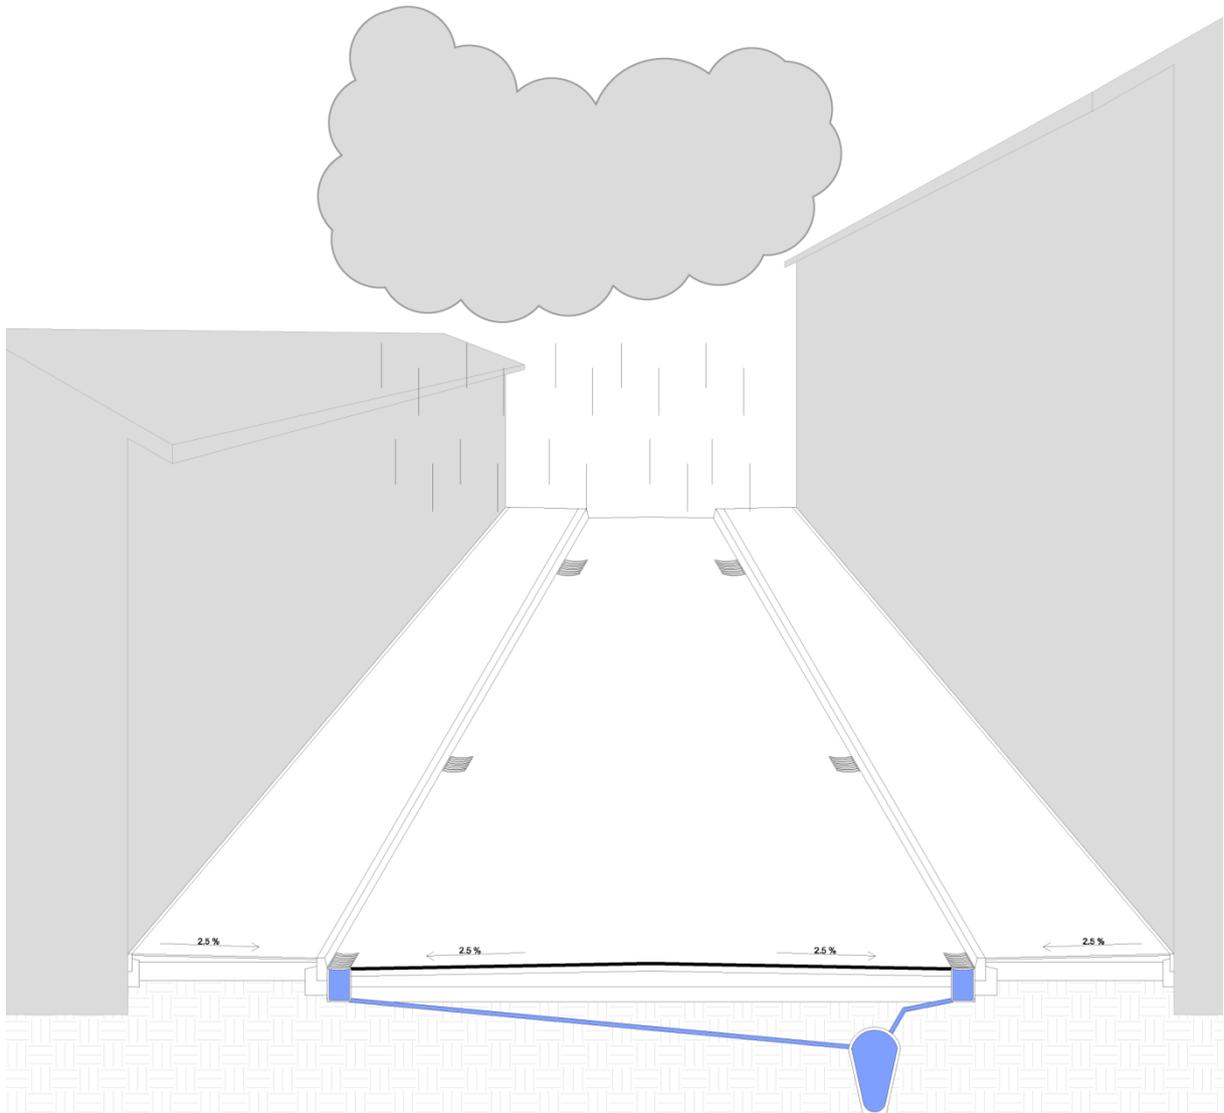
Systemschnitt Straßenentwässerung versiegelte Flächen
